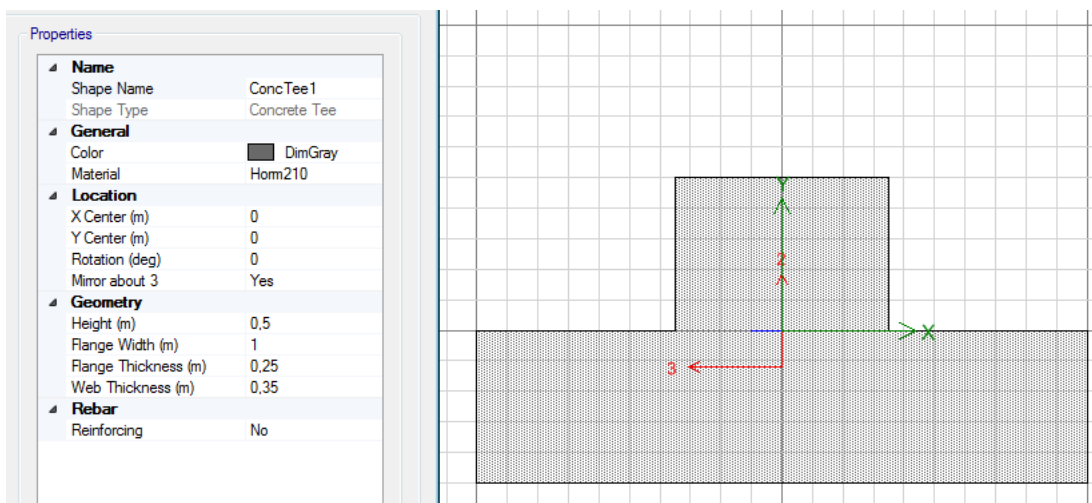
Sección VC2 viga de cimentación (Etabs2015)
